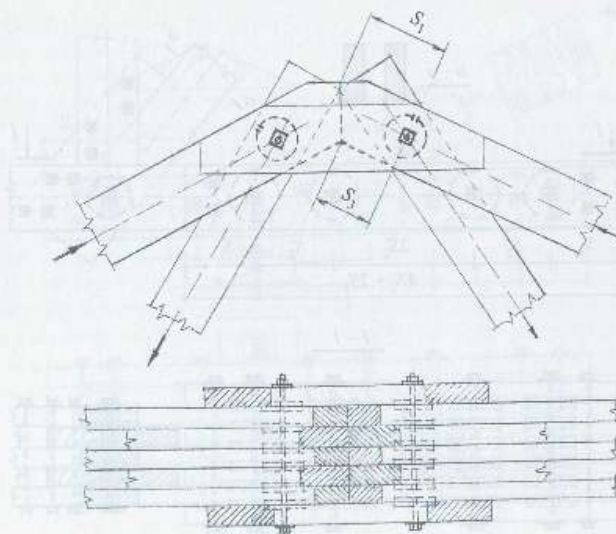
Средний узел верхнего пояса фермы на гладких кольцевых шпонках
